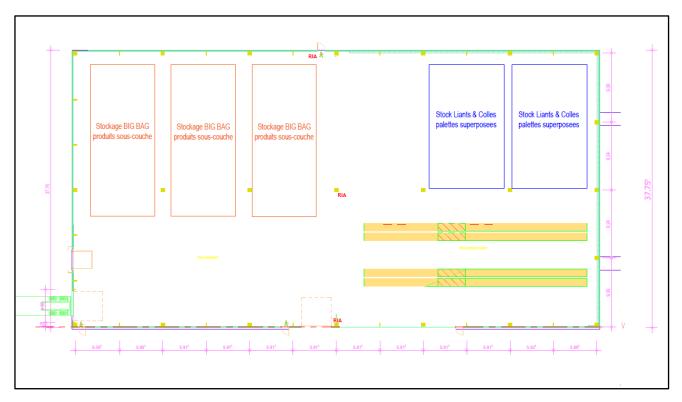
Stockage futur bâtiments (source : sicabconstruction)
